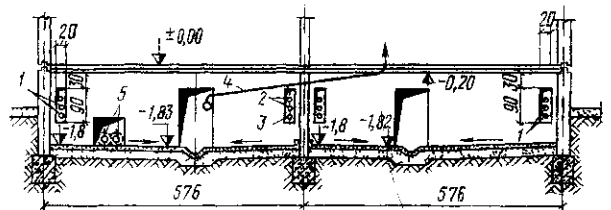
Схема размещения коммуникаций в техническом подполье здания при строительстве на просадочных грунтах
